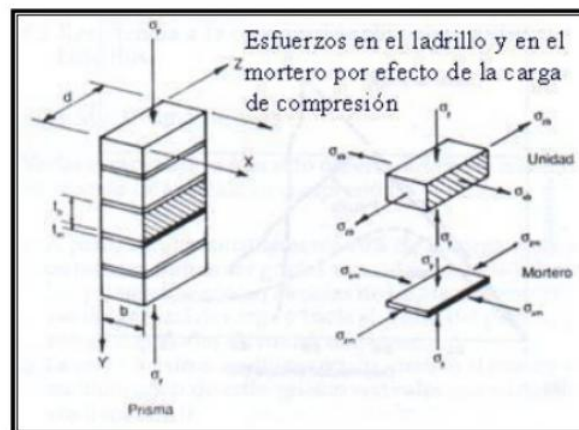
Esfuerzo de compresión axial en las pilas de albañilería
